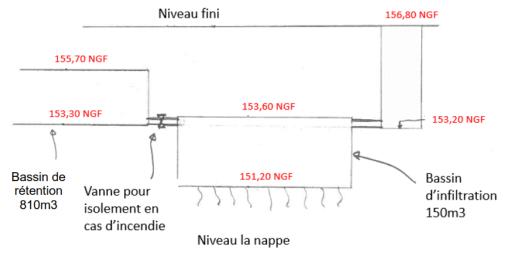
Coupe de principe de la gestion des eaux pluviales sur site
